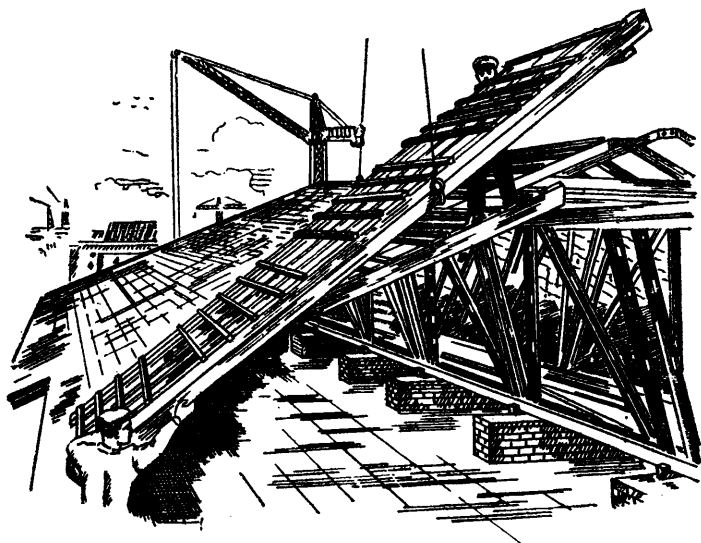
Установка укрупненного стропильного щита с обрешеткой башенным краном.
